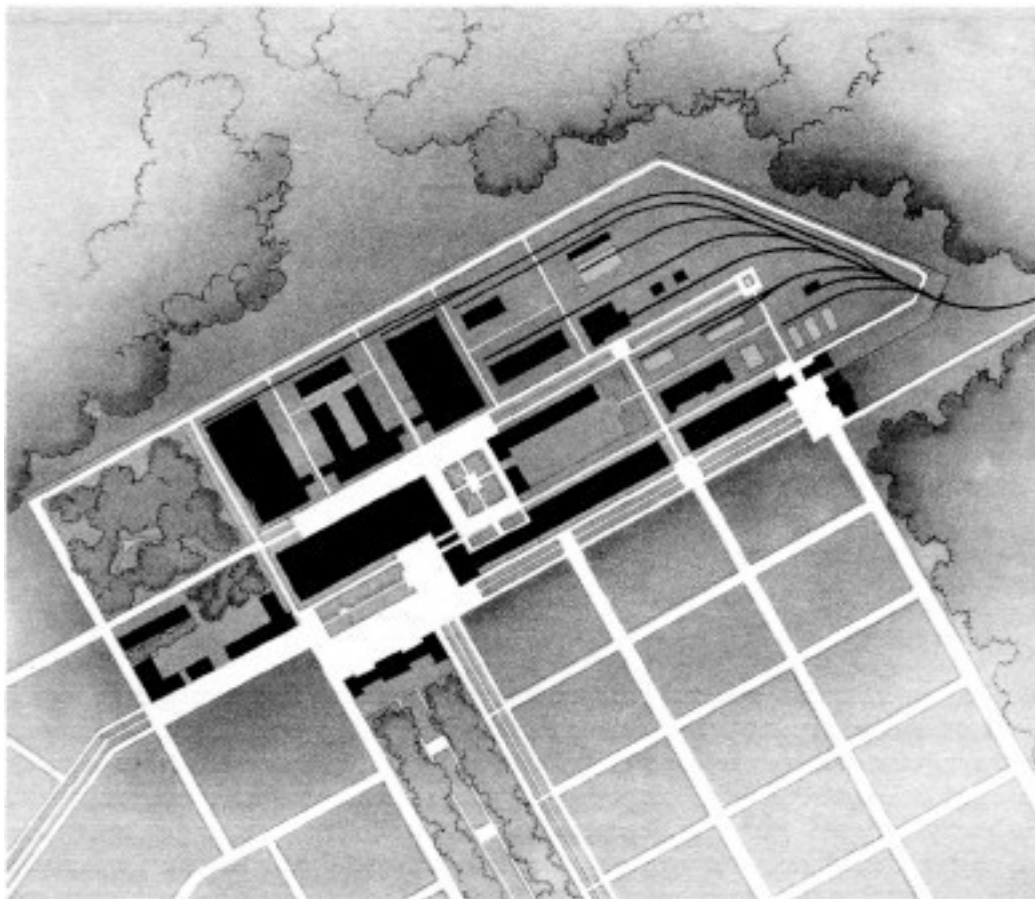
Схематический прием изображения генерального плана. План промышленной площадки. Чертеж выполнен в линиях с монохромной обработкой тушью или темной акварельной краской.
